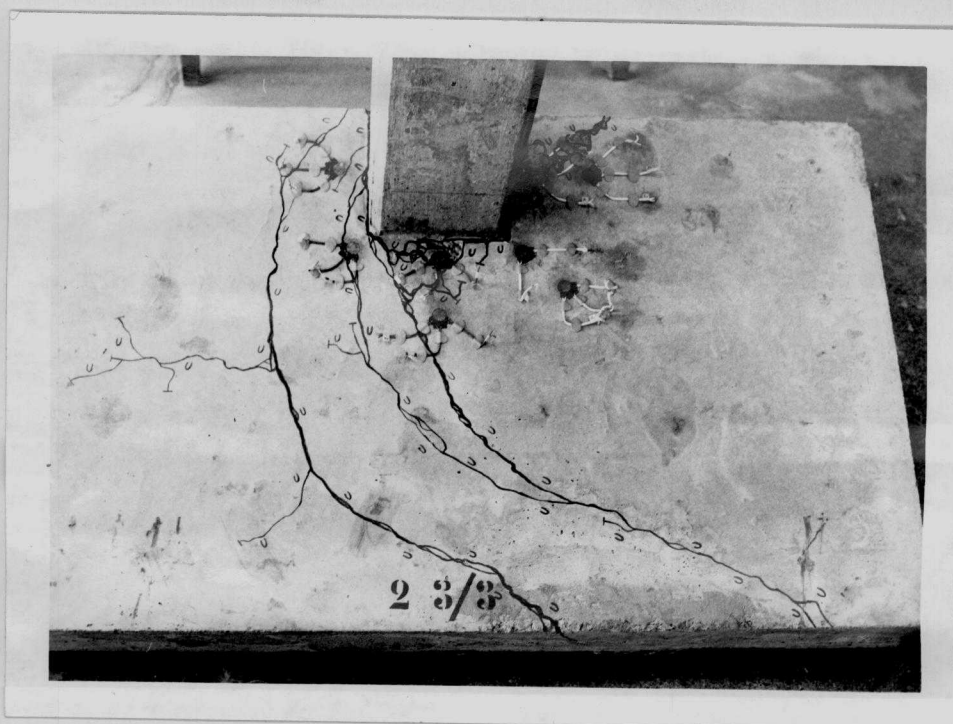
c - Fissuração na face inferior do modelo EdL 23/3.
